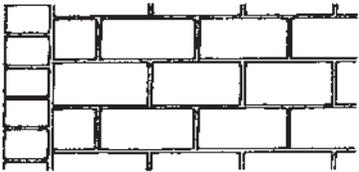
Vista en planta de las figuras 11, 13 y 15.
